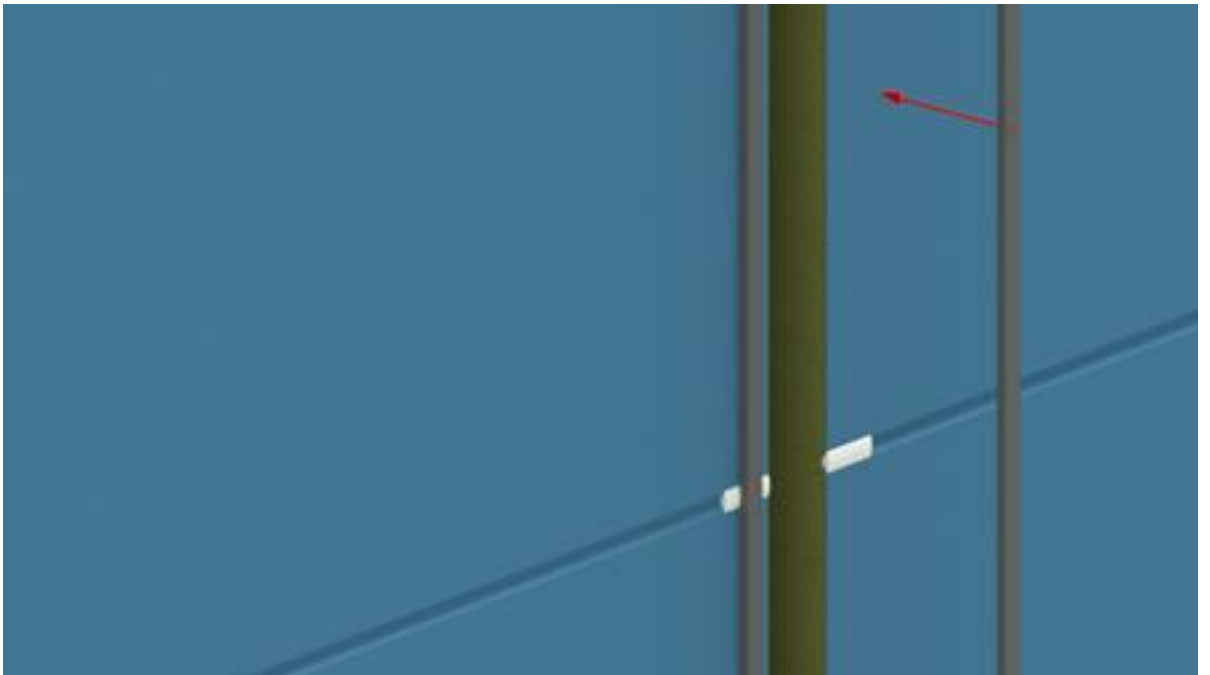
Dispositions particulières avec parement extérieur Twinlook en pose horizontale
